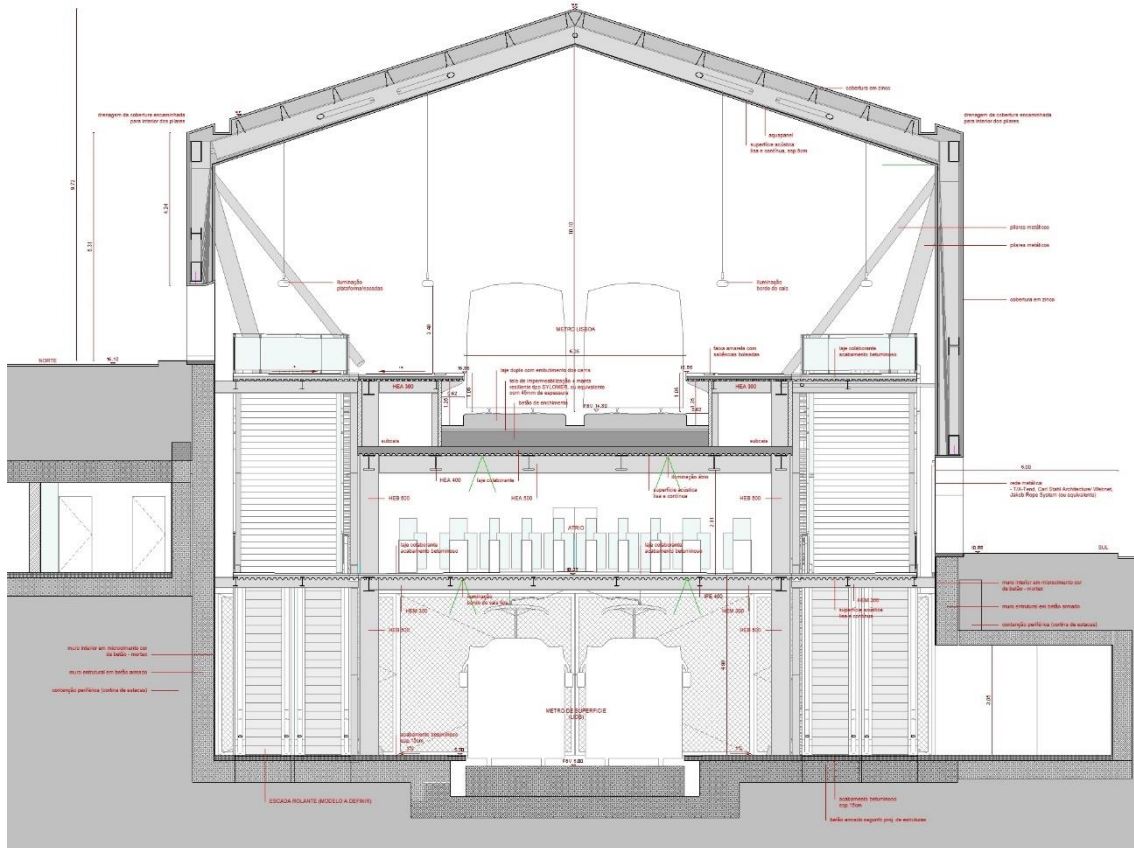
Corte construtivo da Estação (ML 134360).
